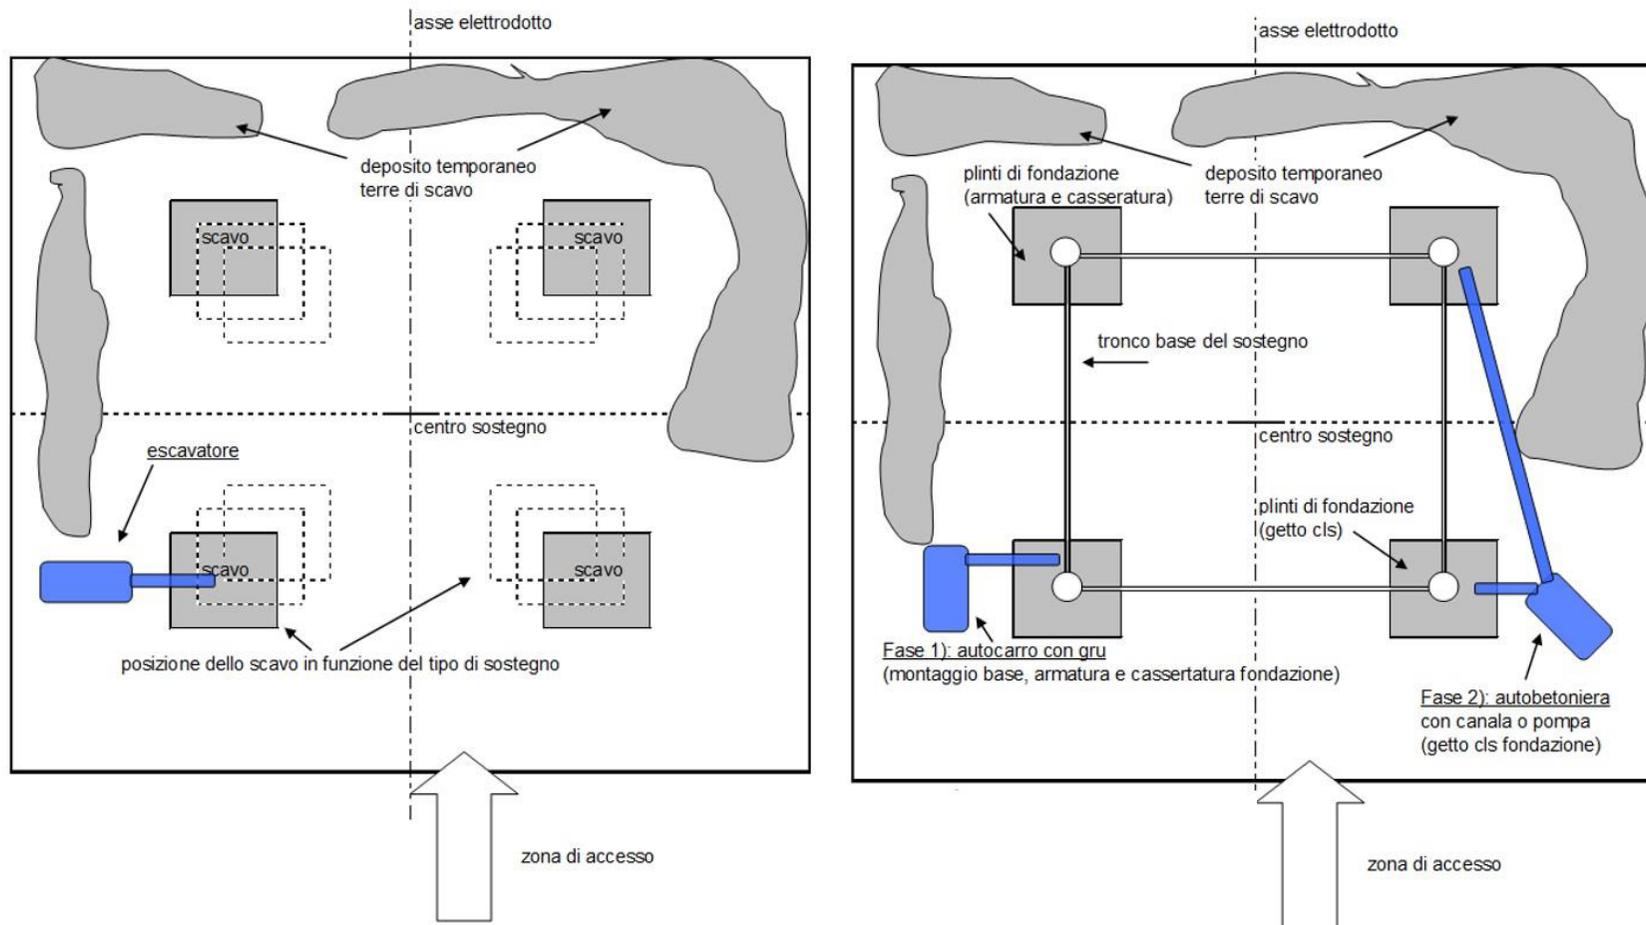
Planimetria dell'Area Sostegno (scavo di fondazione - getto e basi) - Tipologico
